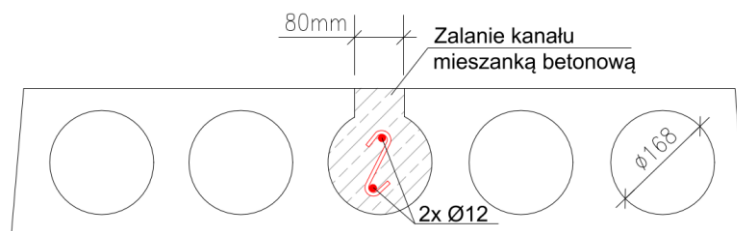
Schemat zalania mieszanką betonową 2 kanałów płyty „G” pod urządzeniem
